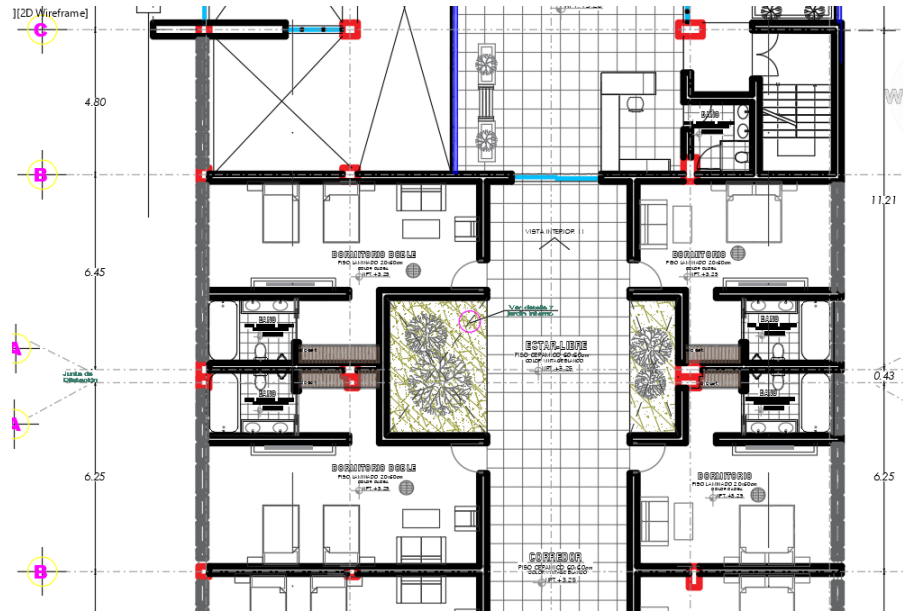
Sección de desarrollo estructural – Segundo nivel, zona hotel.
